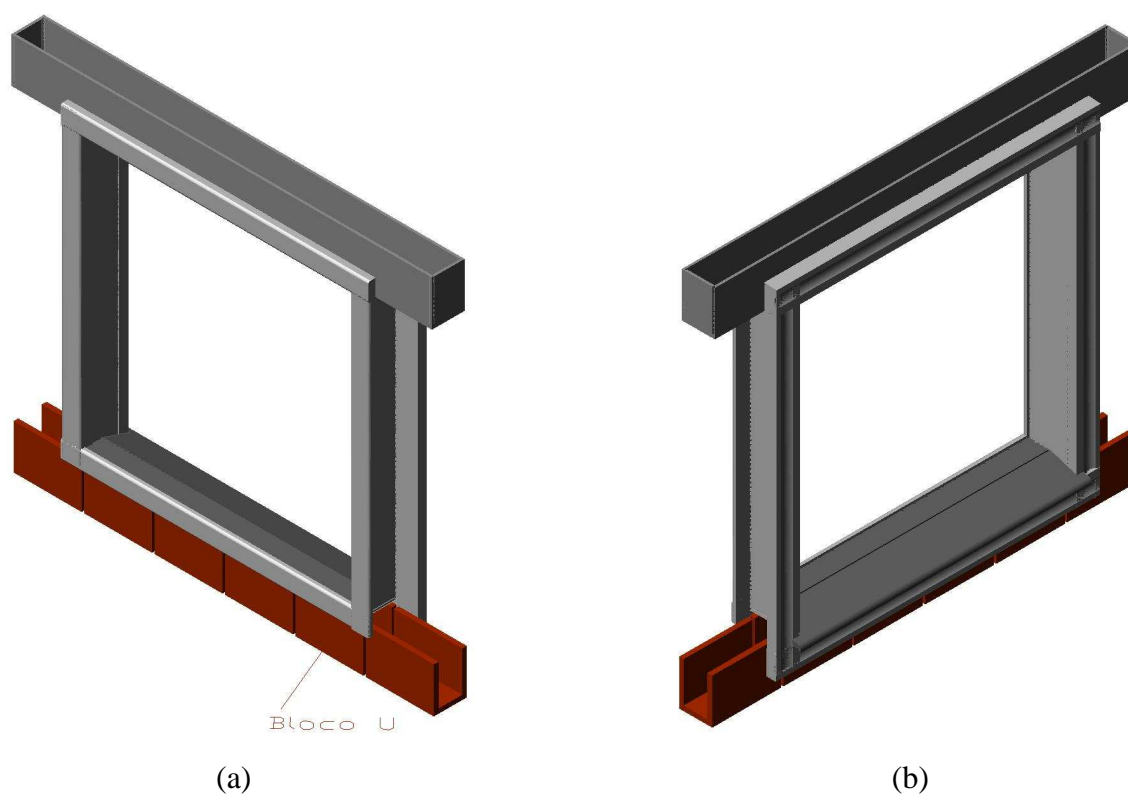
Projeto 02, vista 3d da face interna (a) e vista 3d da face externa (b).
